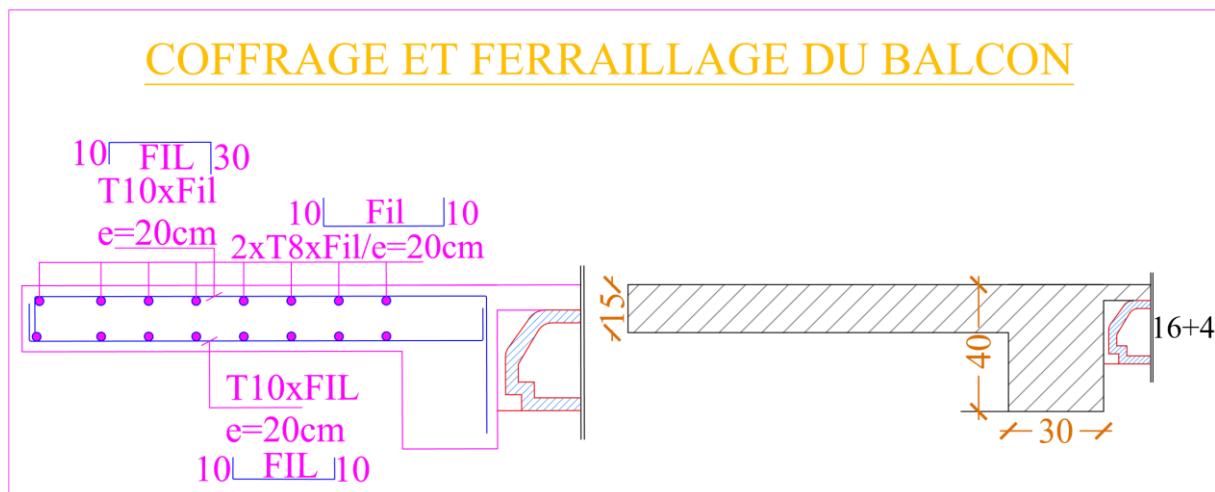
Schéma de ferrailage et coffrage du balcon
